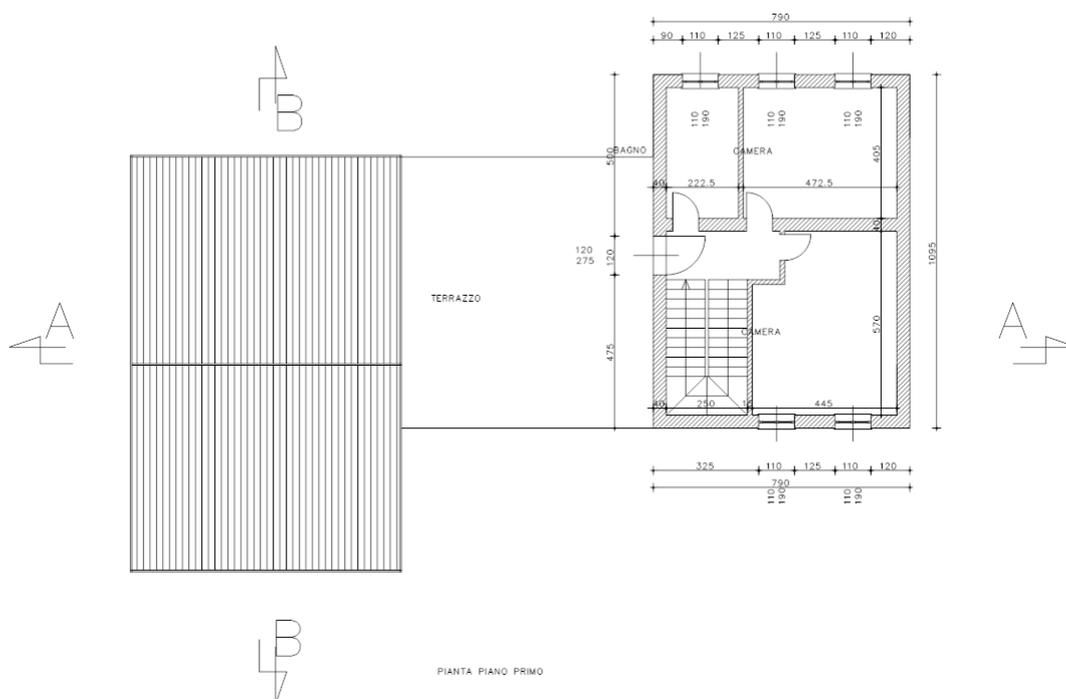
“Casolare di montagna di modesta entità. Pianta Piano primo”
